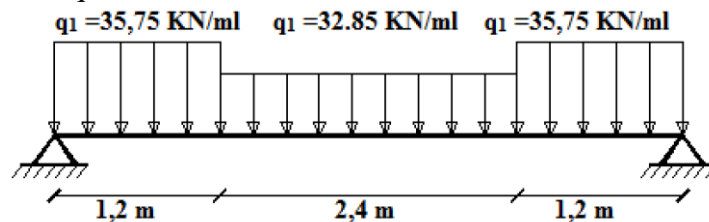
Les Schéma statique d'une poutre brisée
